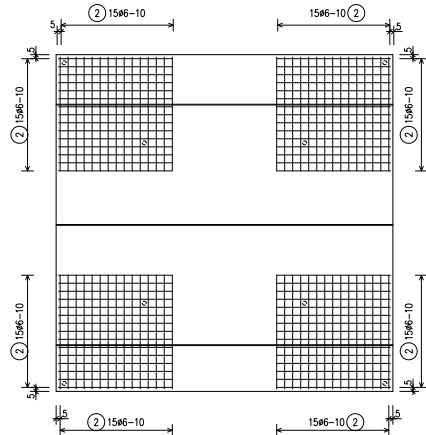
Platte 2, obere Eckbewehrung in Ortbetonergänzung
